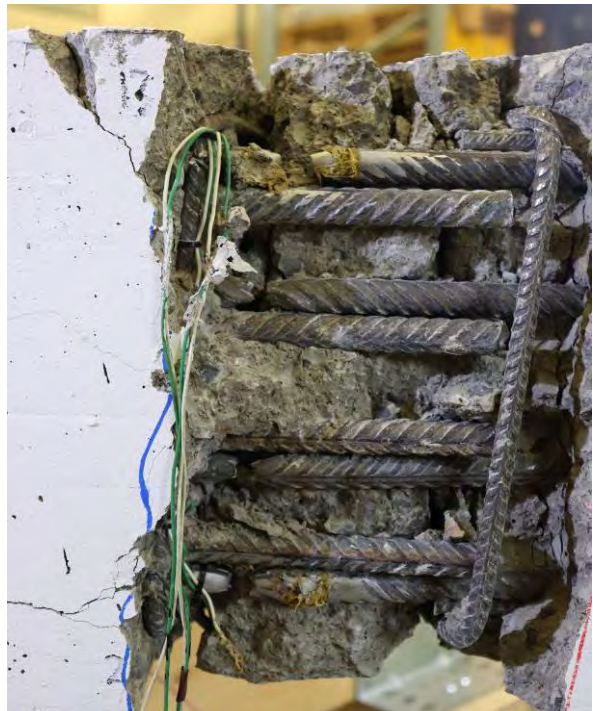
P02-01 Abgerissene Biegezugbewehrung und Betonausbruch.
